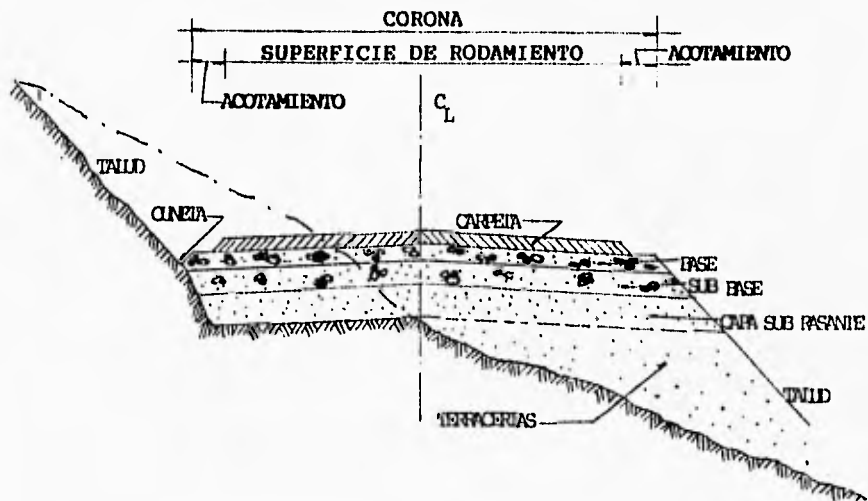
Sección Típica de un pavimento flexible en una sección en balcón.
